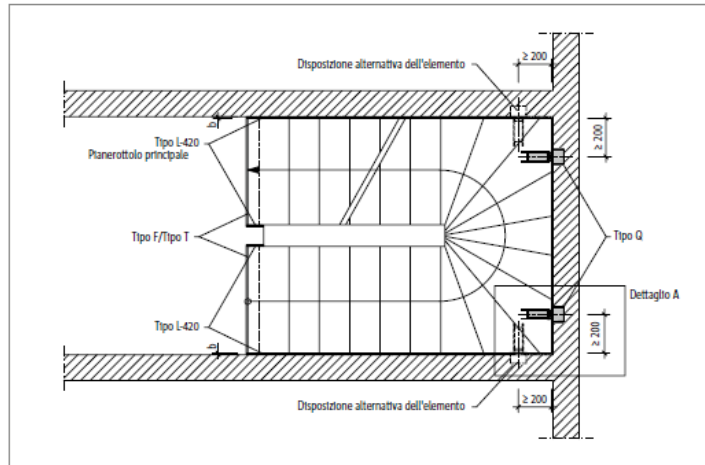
Schöck Tronsole® tipo Q, disposizione dell'elemento nella pianta mediante Tronsole® tipo L
